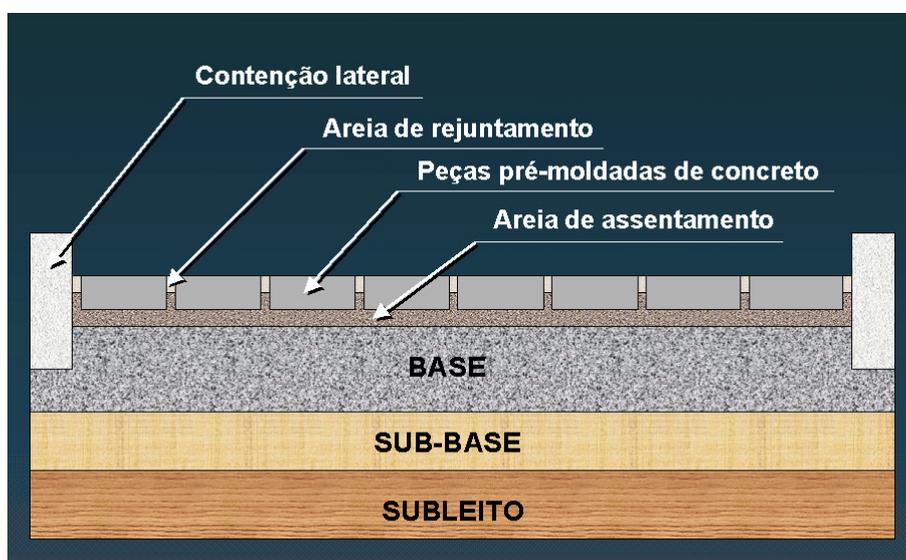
Perfil das camadas do pavimento intertravado, onde se observa o colchão de areia de assentamento sobre a base (HALLACK, 1998)
